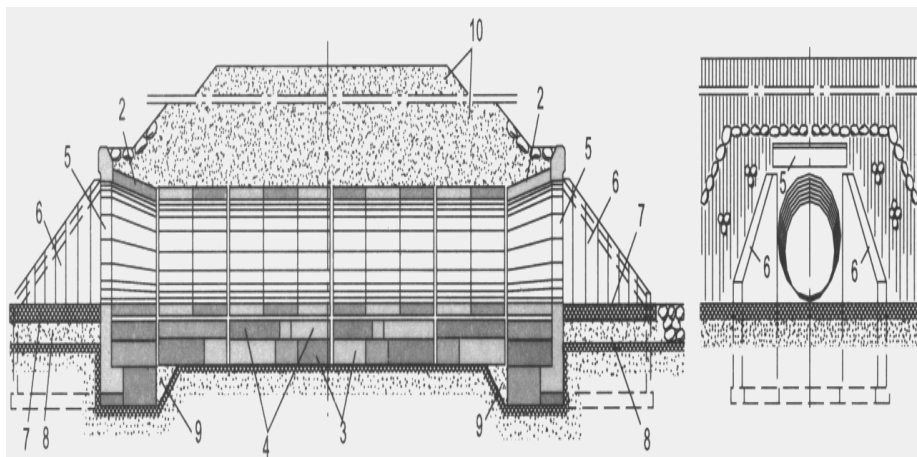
Конструкция одноочковой железобетонной трубы:
